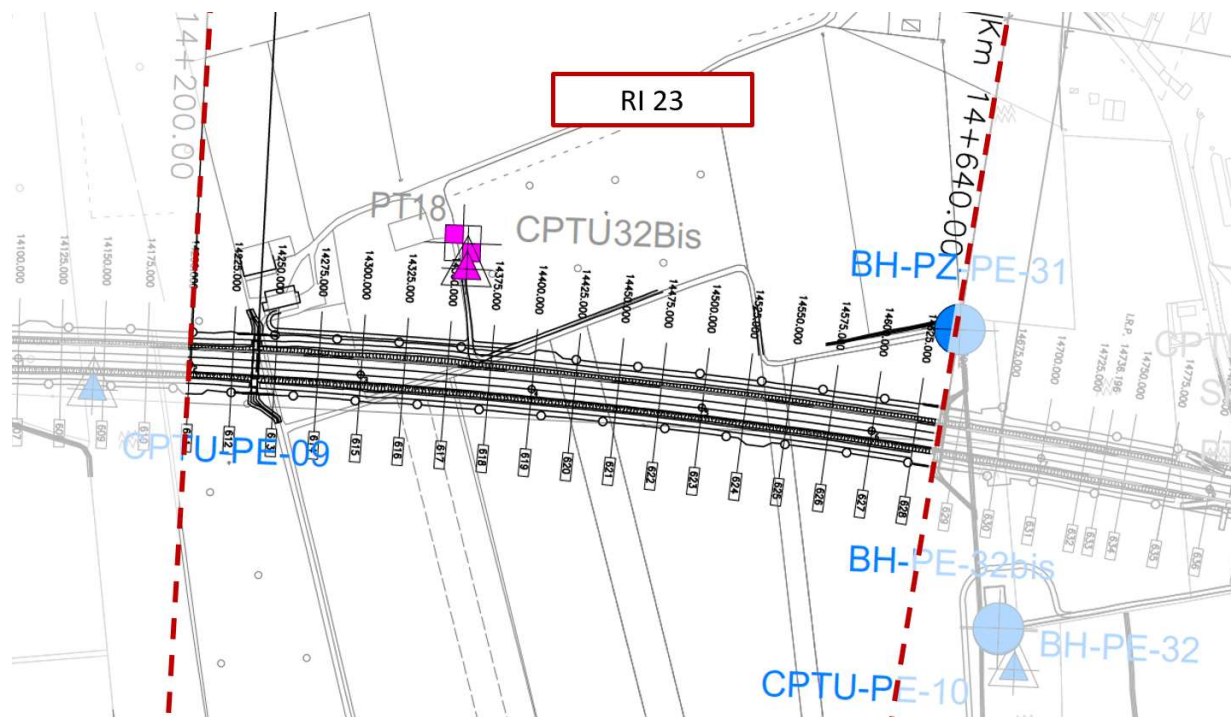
Planimetria Rilevato RI23, estratto dalla Planimetria Generale (Doc. Rif. [3])
